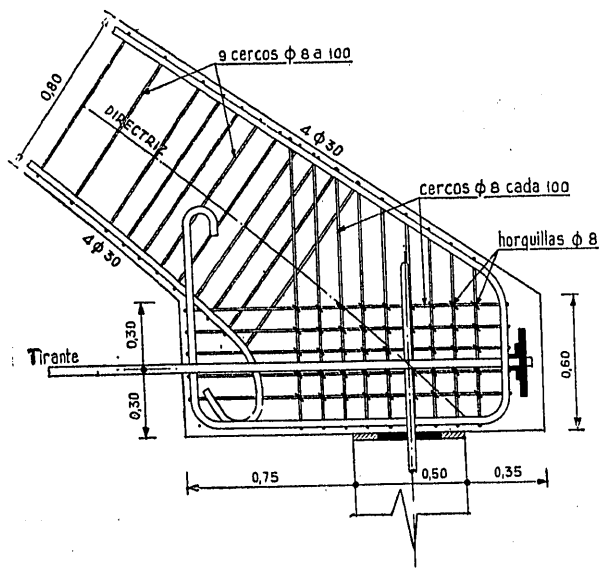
ª — Detalle de una extremidad del arco de 40 m.
